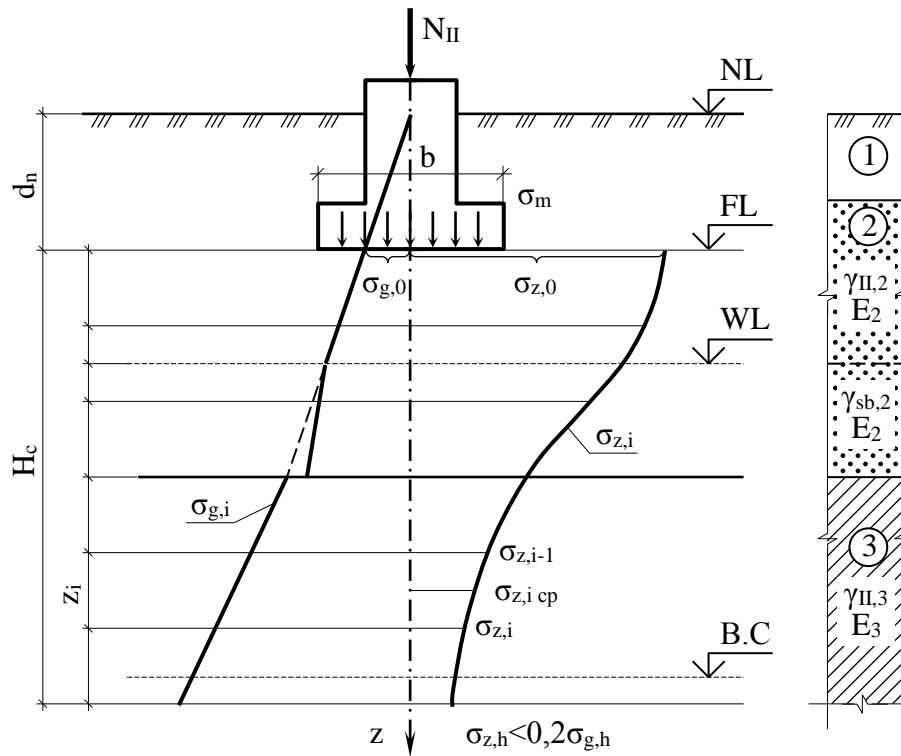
Схема до розрахунку осідань методом пошарового підсумування
